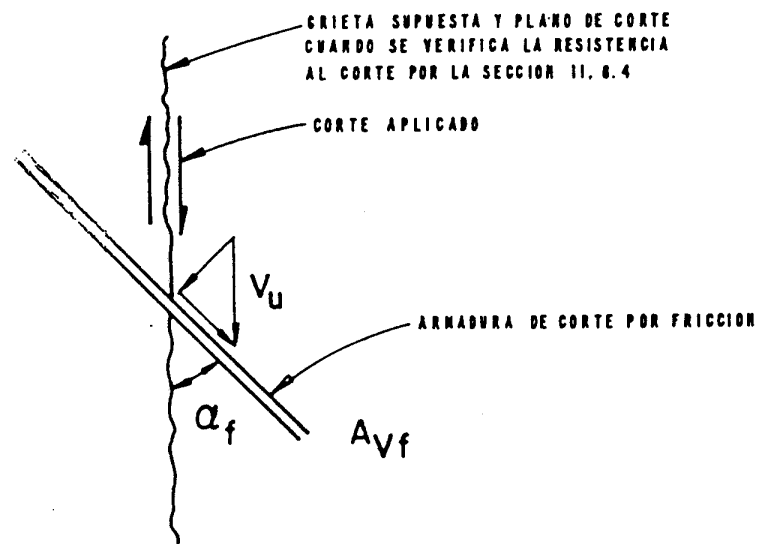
6. 4 ARMADURAS DE CORTE POR FRICCION INCLINADAS CON RESPECTO AL PLANO DE CORTE
